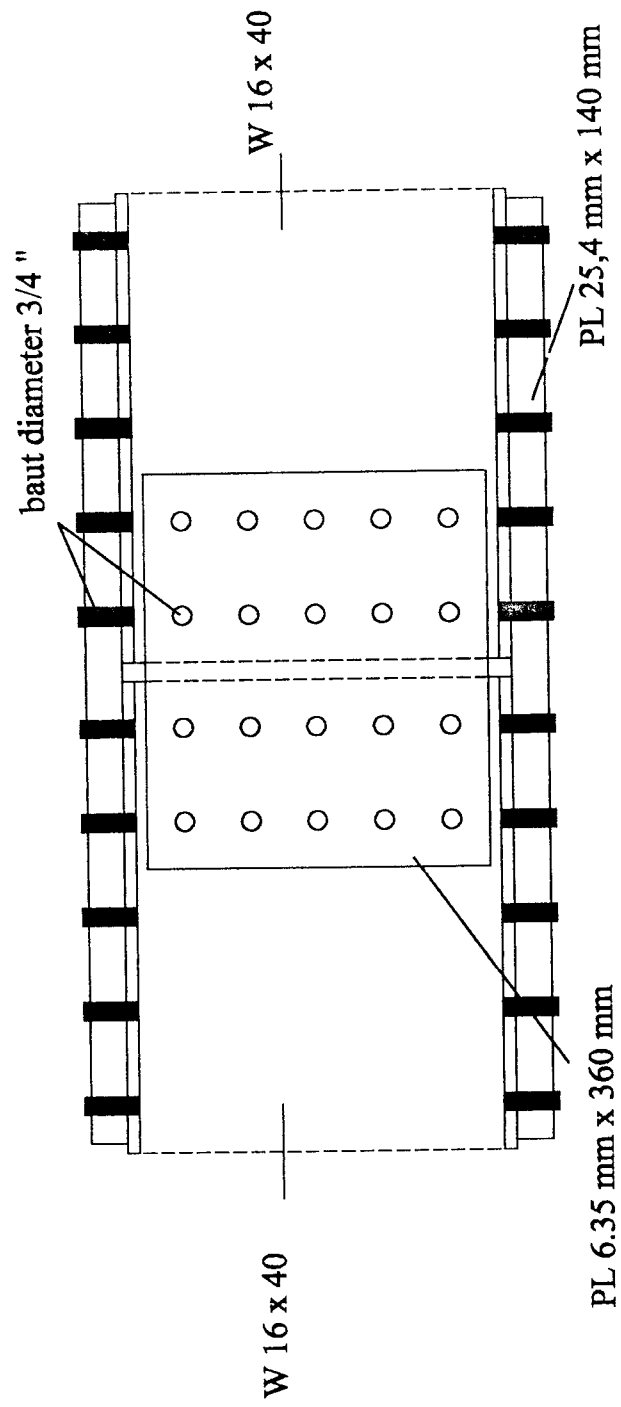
DETAIL SAMBUNGAN PADA JOIN LANTAI 2,3,4 PORTAL 6
